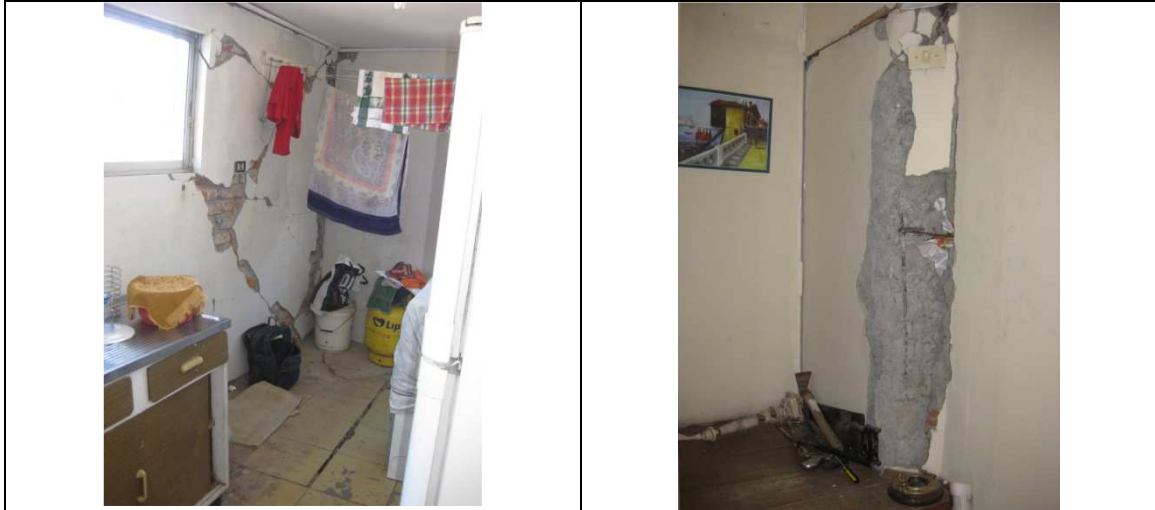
Casas hundidas y agrietadas en calle Atacama, sector Calero Sur, Lota.
